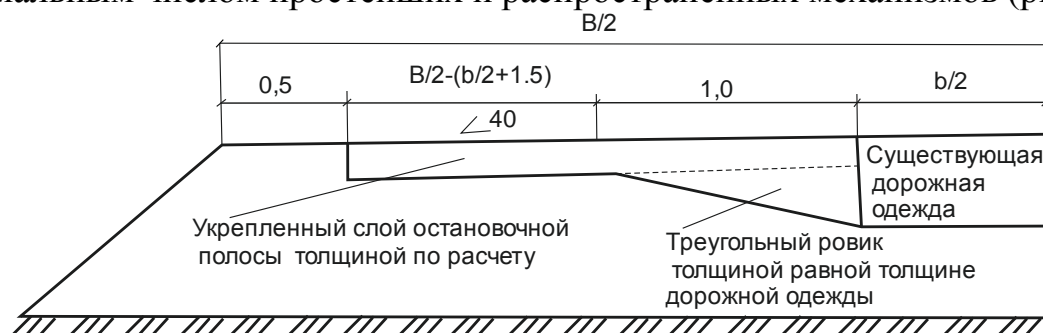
Конструкция укрепления обочины эксплуатируемых дорог на дренирующих грунтах земляного полотна
